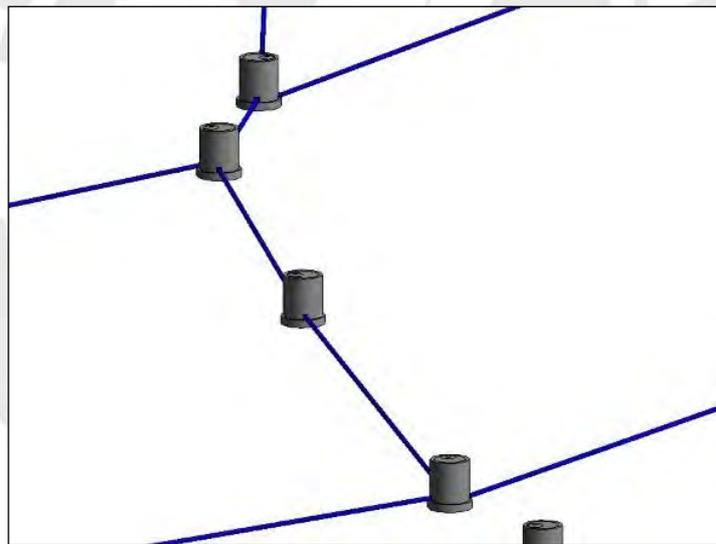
Modelado de tuberías de la red de alcantarillado del proyecto en el programa Revit
